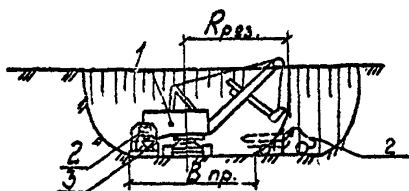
Схема разработки грунтов экскаватором лобовым забоем.
